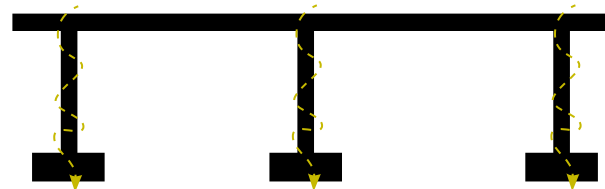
Ductibilidad Estructural Adaptado de (NEC,2018)
